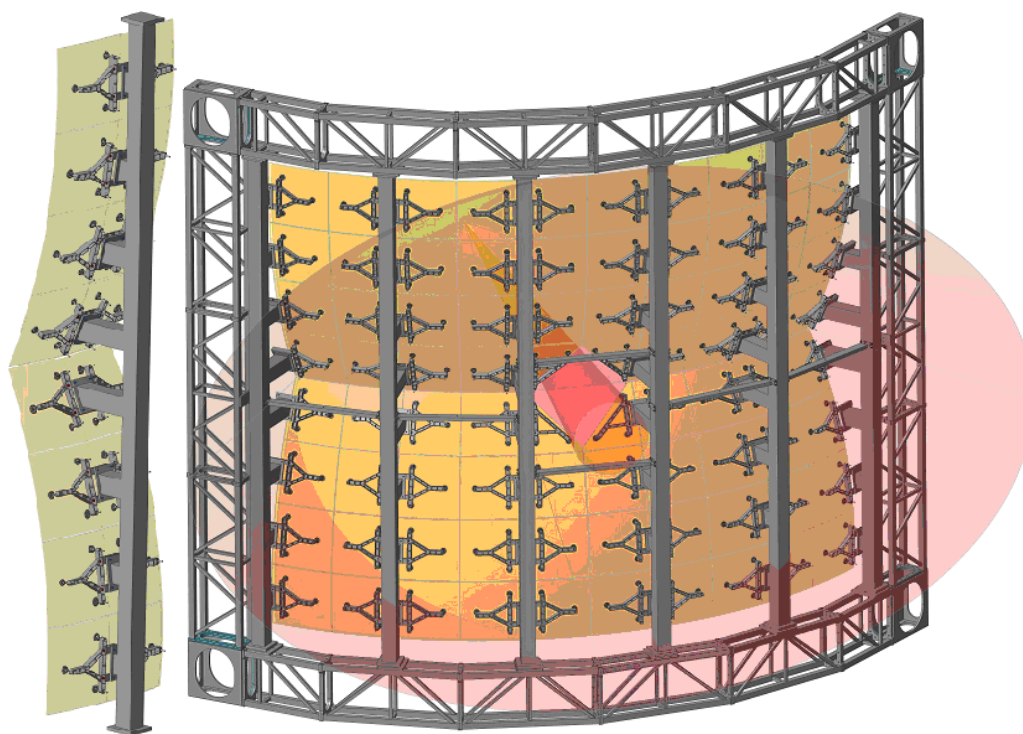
Схематический вид расположения зеркальных плиток
